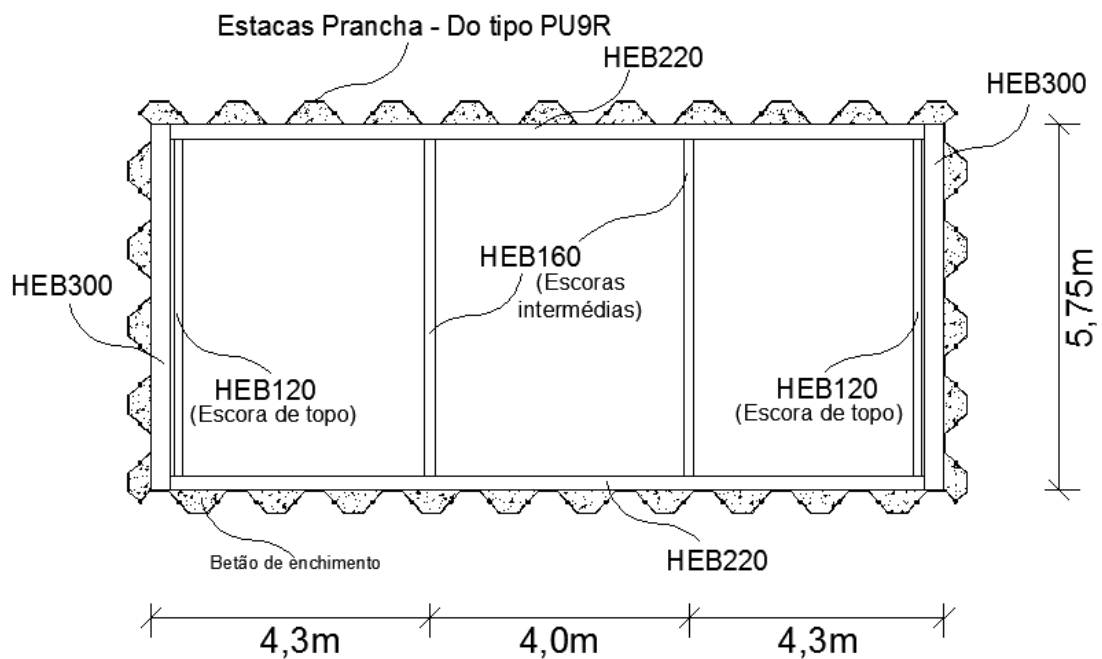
Apoio superior da cortina: Planta de escoramento à cota +2,18
